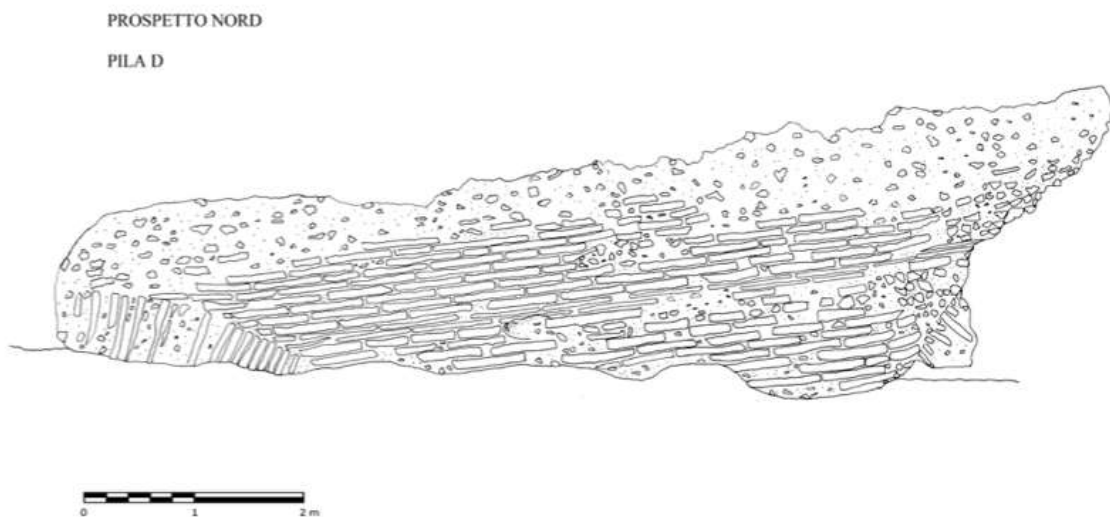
Centuripe, ponte romano di contrada Paportello: Pila D, prospetto lato nord (da DI BENEDETTO 2017).
